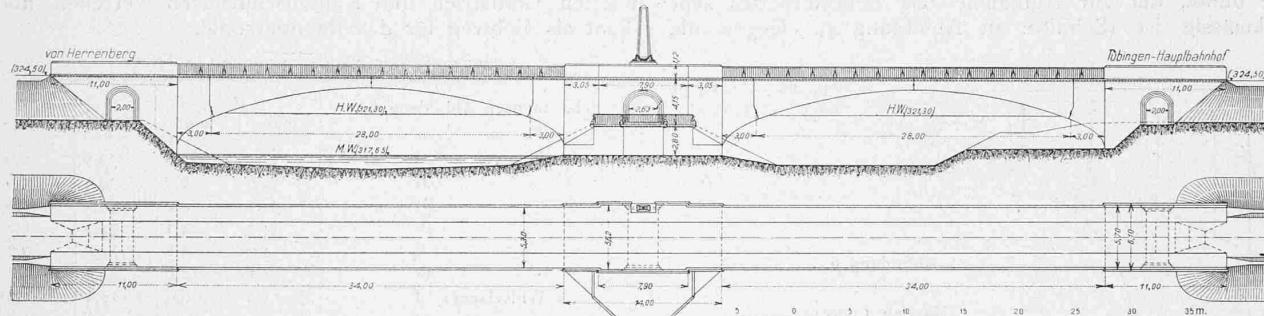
Grundriss und Ansicht von der Oberwasserseite. — Maßstab 1:600.
